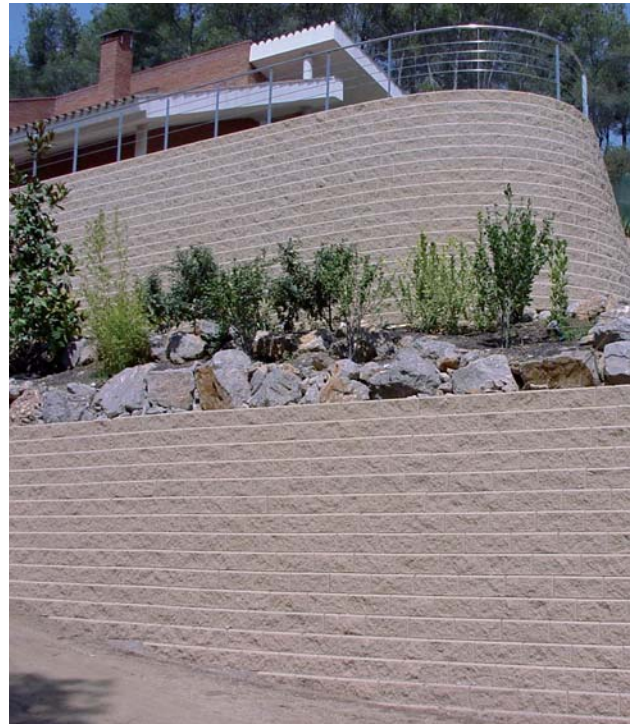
Empleo de mampostería de hormigón en muros de cerramiento con distintas geometrías, colores y acabados.
